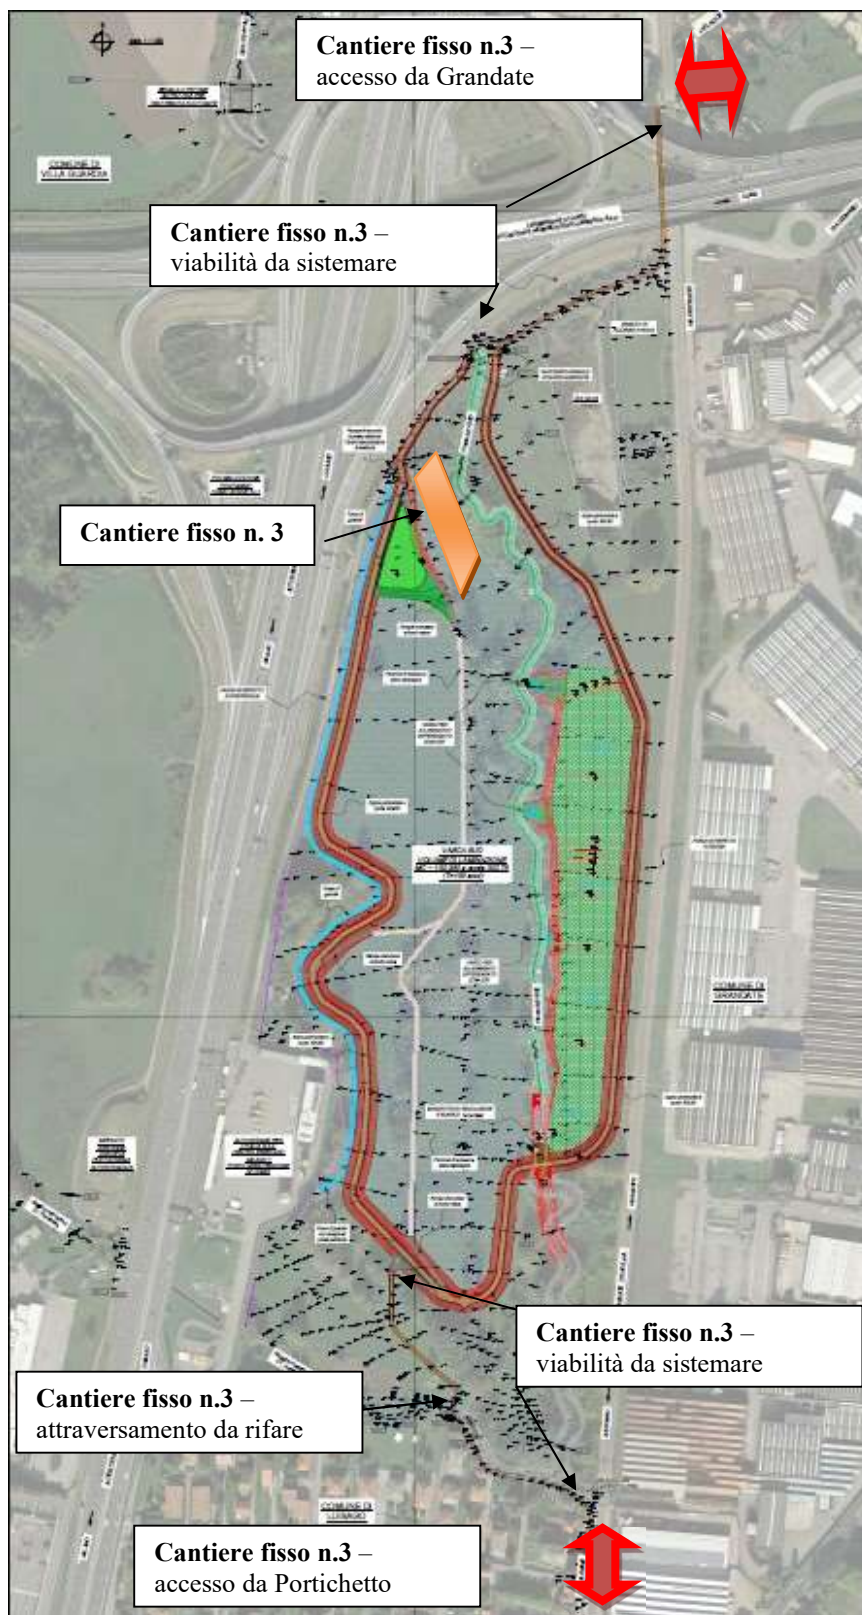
localizzazione cantiere fisso n. 3 ed accessibilità
